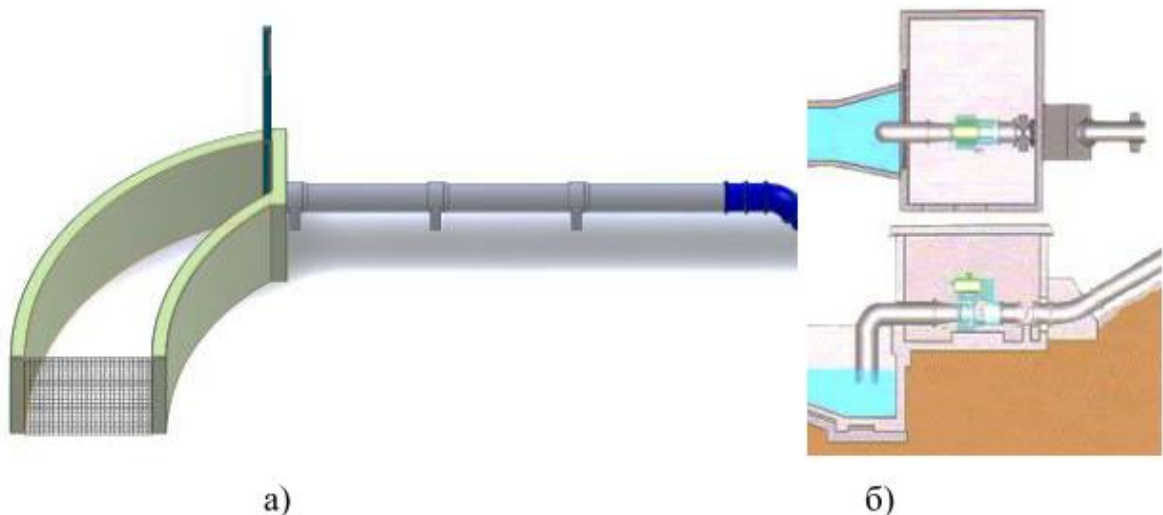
Гідропоруди мікроГЕС на річці Бронька: а) водозабірний вузол з напірним трубопроводом; б) будівля з енергообладнанням
